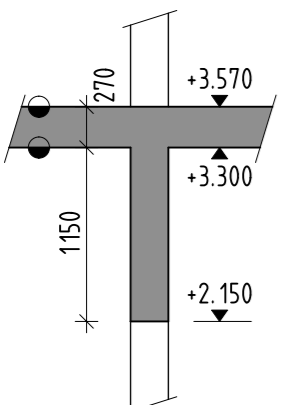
POHLED NA PILÍŘ S NÁBĚHEM
